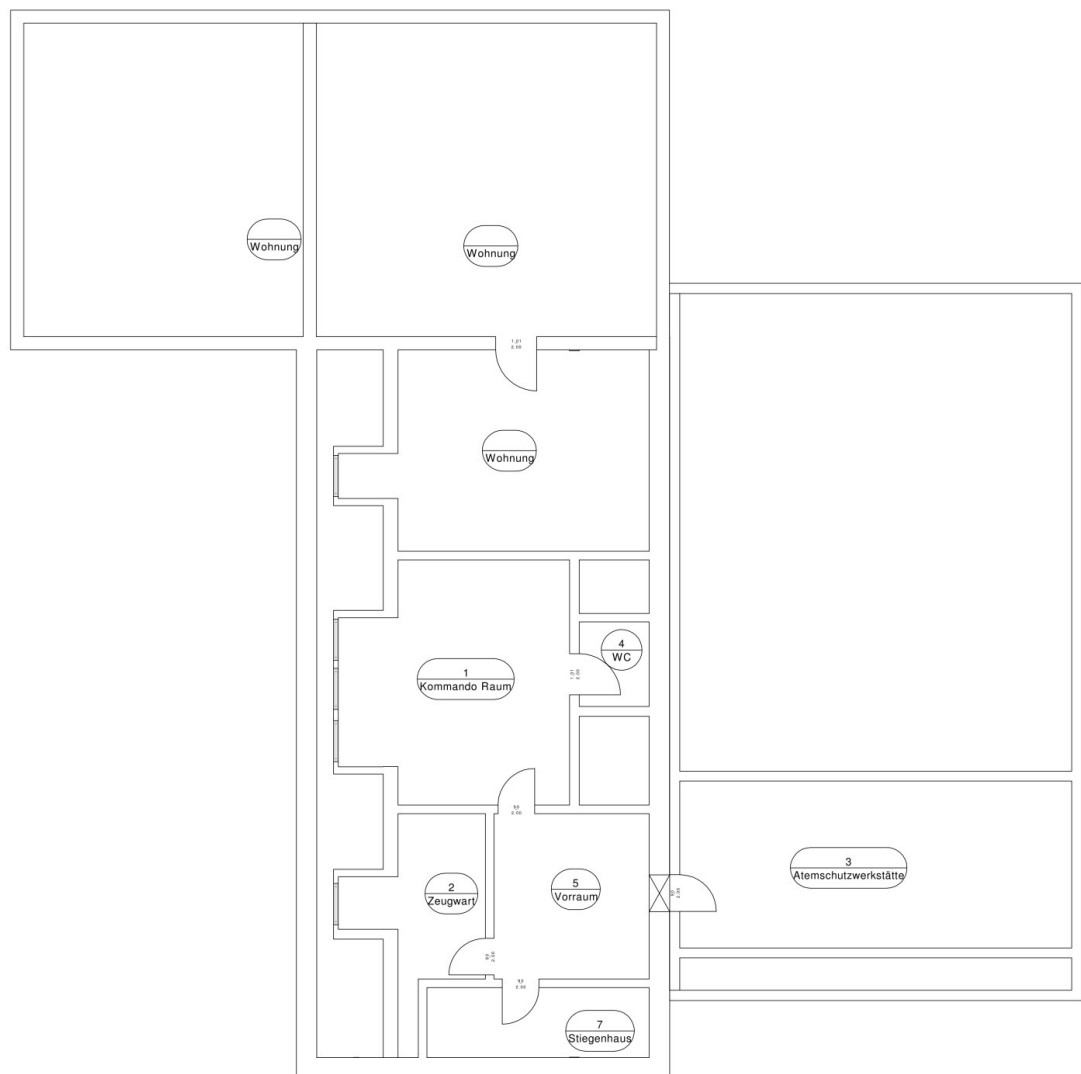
Grundriss EG FF Langenwang <sup>6</sup>
